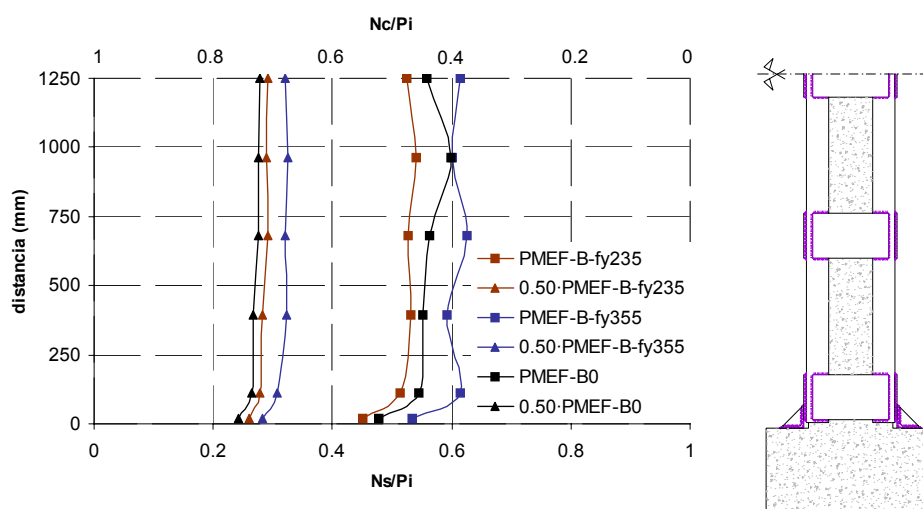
Reparto de cargas entre el refuerzo y el hormigón. Probetas B-fy235 y B-fy355
